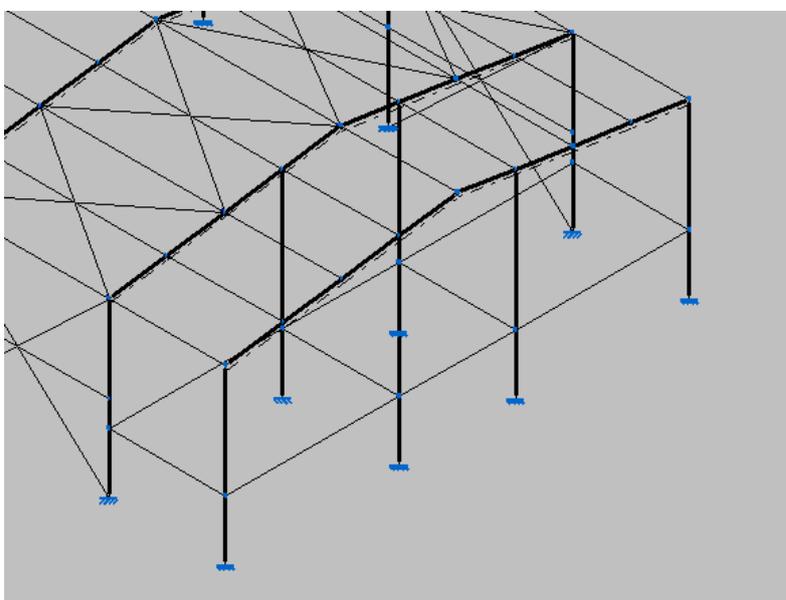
Pilares centrales. Fuente: CYPE 2017
